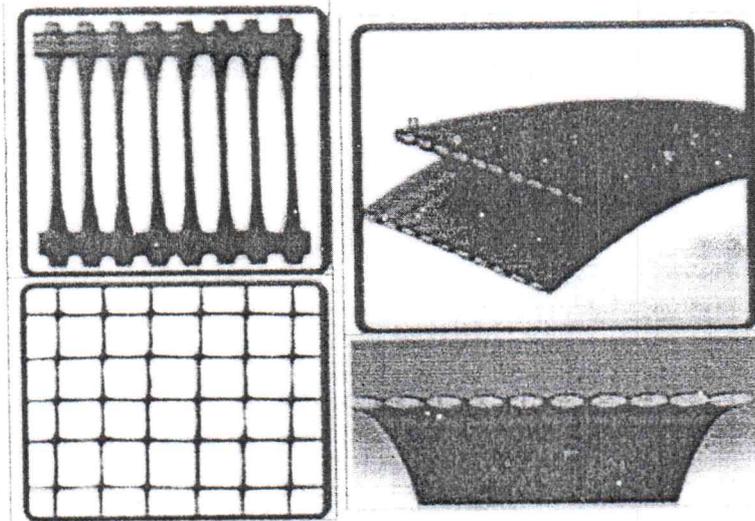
Refuerzo sintético tipo malla y tipo banda
